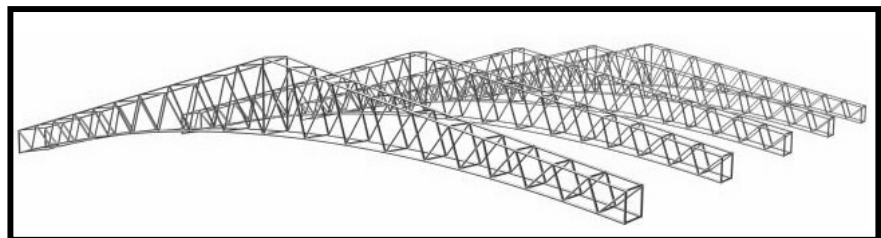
Flächige Dachstruktur bestehend aus paarweise verbundenen Fachwerkebenen
